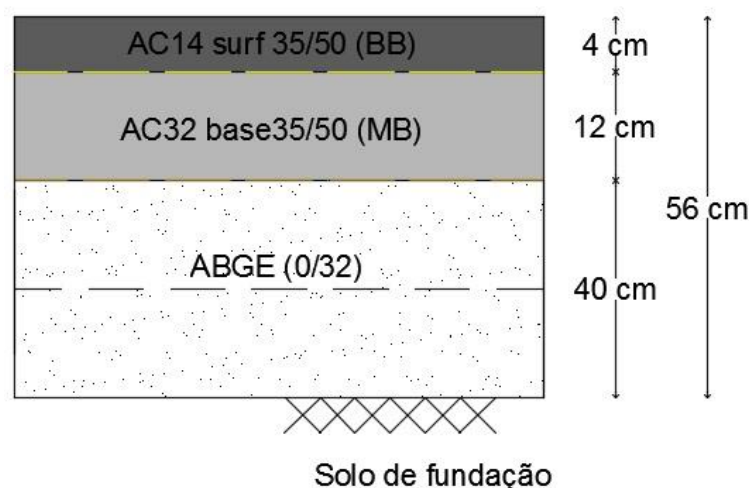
Estrutura do novo pavimento da Rua Heróis do Ultramar
